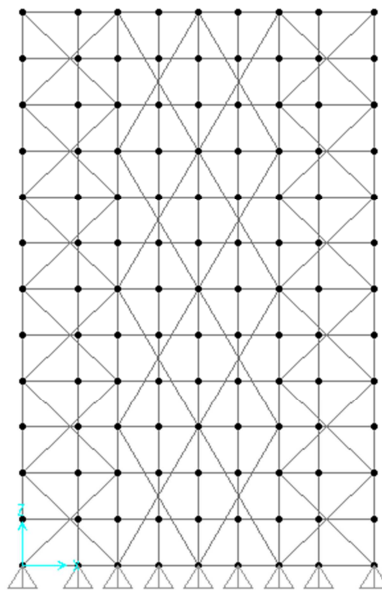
Configuração dos Planos de Contraventamento Vertical Com Elementos de Contraventamento Grandes
